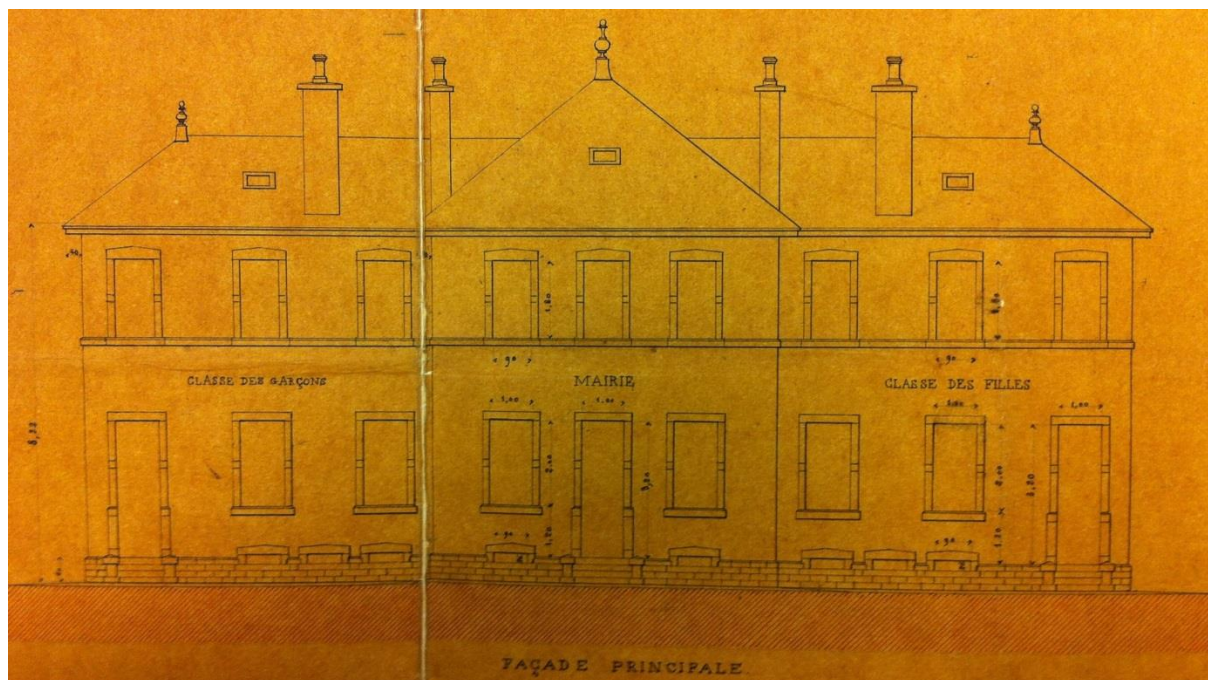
Plan de la façade de la Mairie-école 1884 (1M1).
